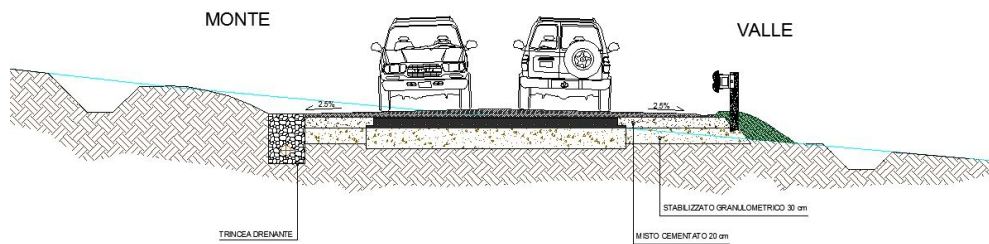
Sezione tipo a mezzacosta con trincea drenante
